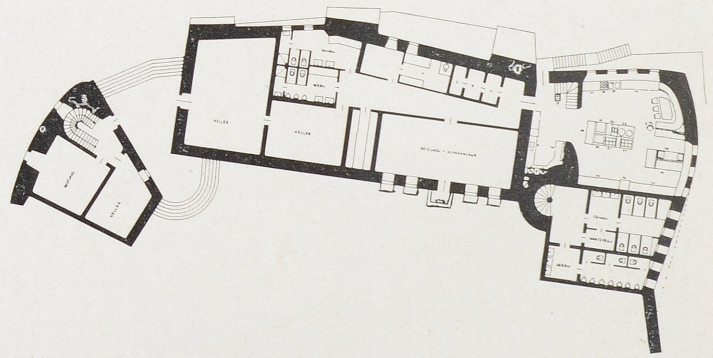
Die Godesburg. Grundriß Kellergeschoß mit Burgeingang
